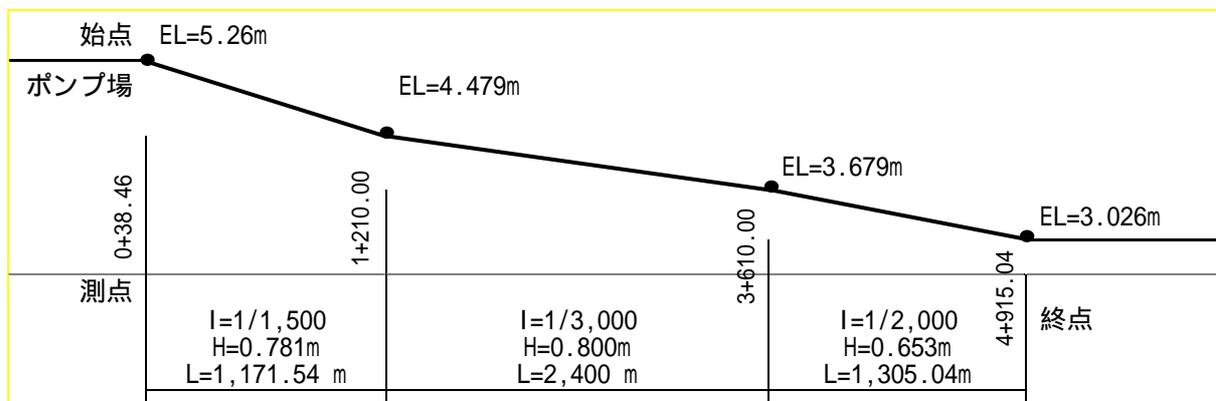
Nam Trung 水路縦断模式図
